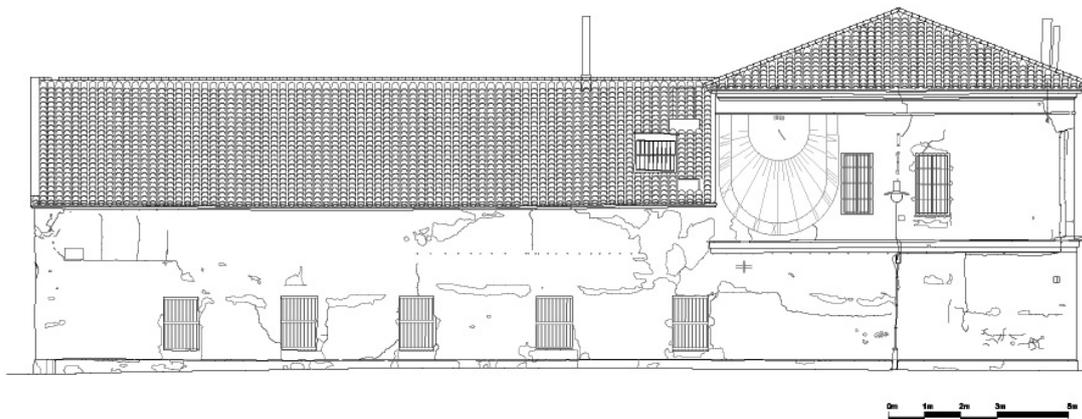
Fotoplano y dibujo de la fachada sur de la Casa dels Bous
